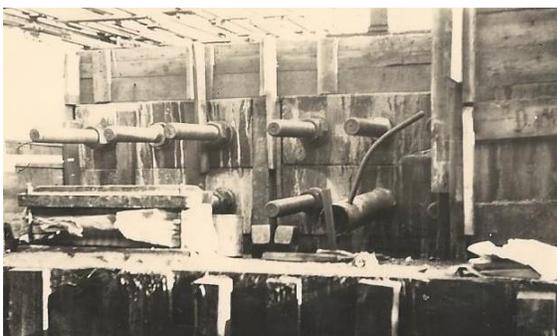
Ankerwand nach Betonierung 02.10.1936 (Foto Herr Fischer)
